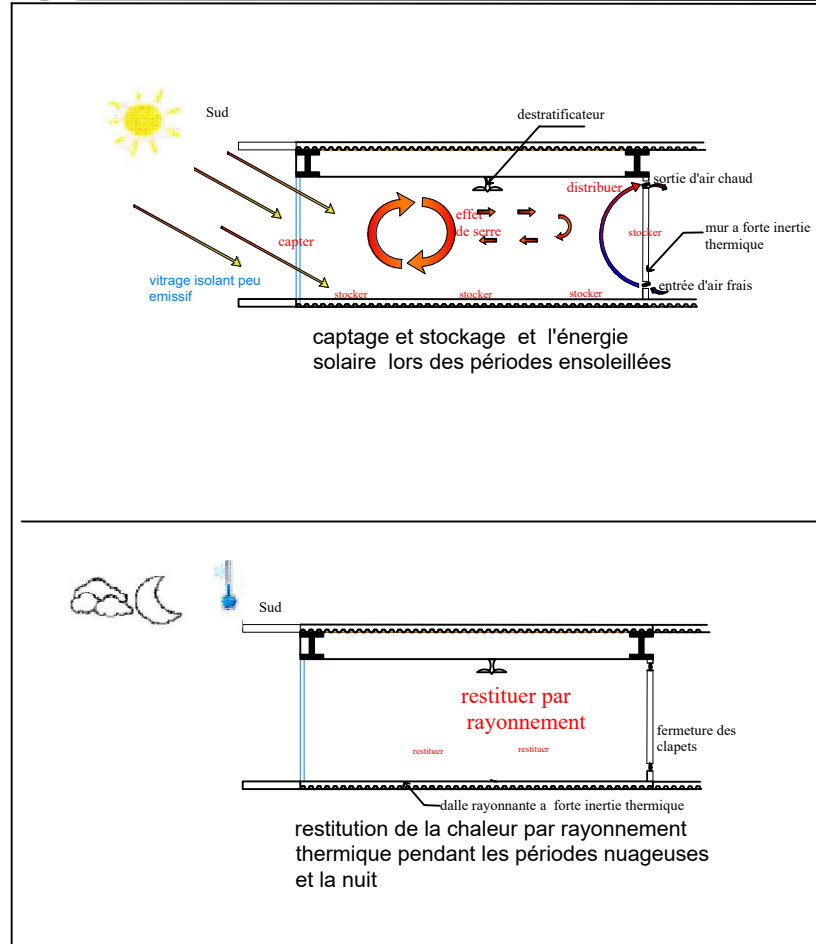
zoom sur le plancher chauffant coupe A-A
